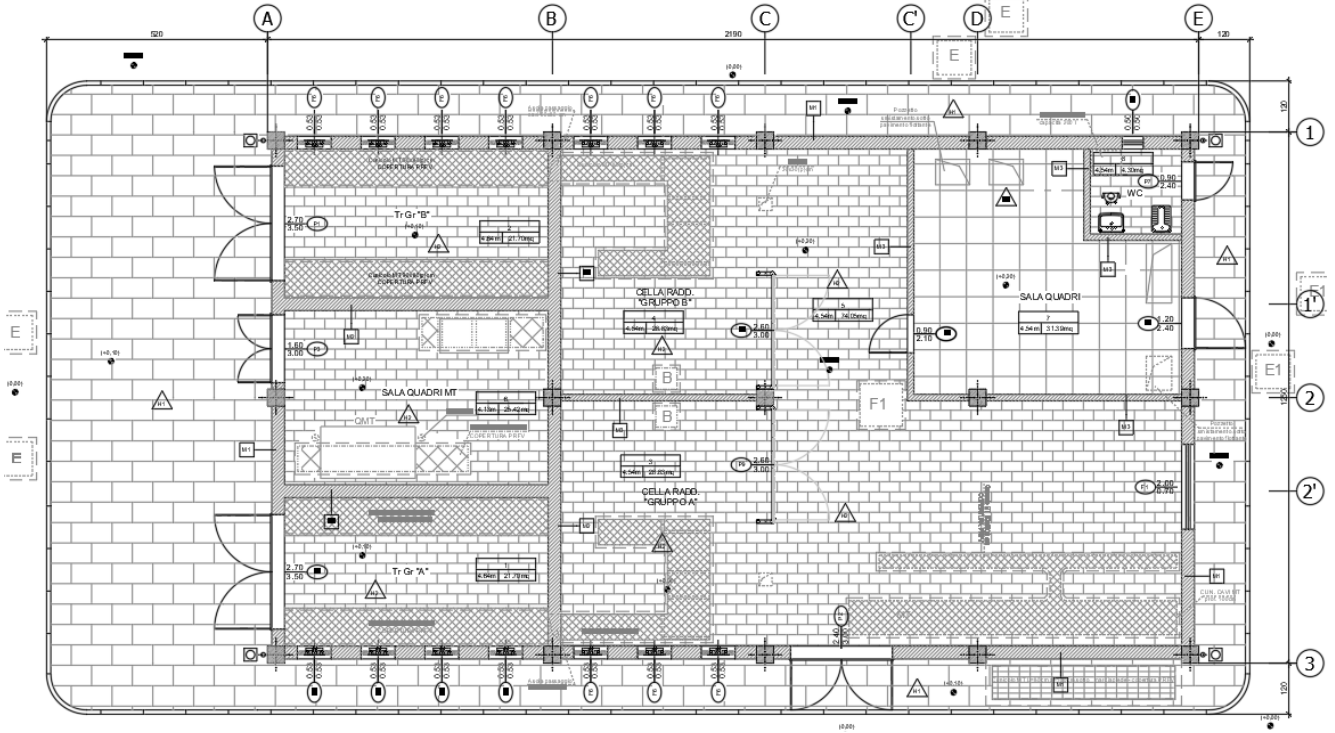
SSE Ripalta - Pianta architettonica del piano terra
